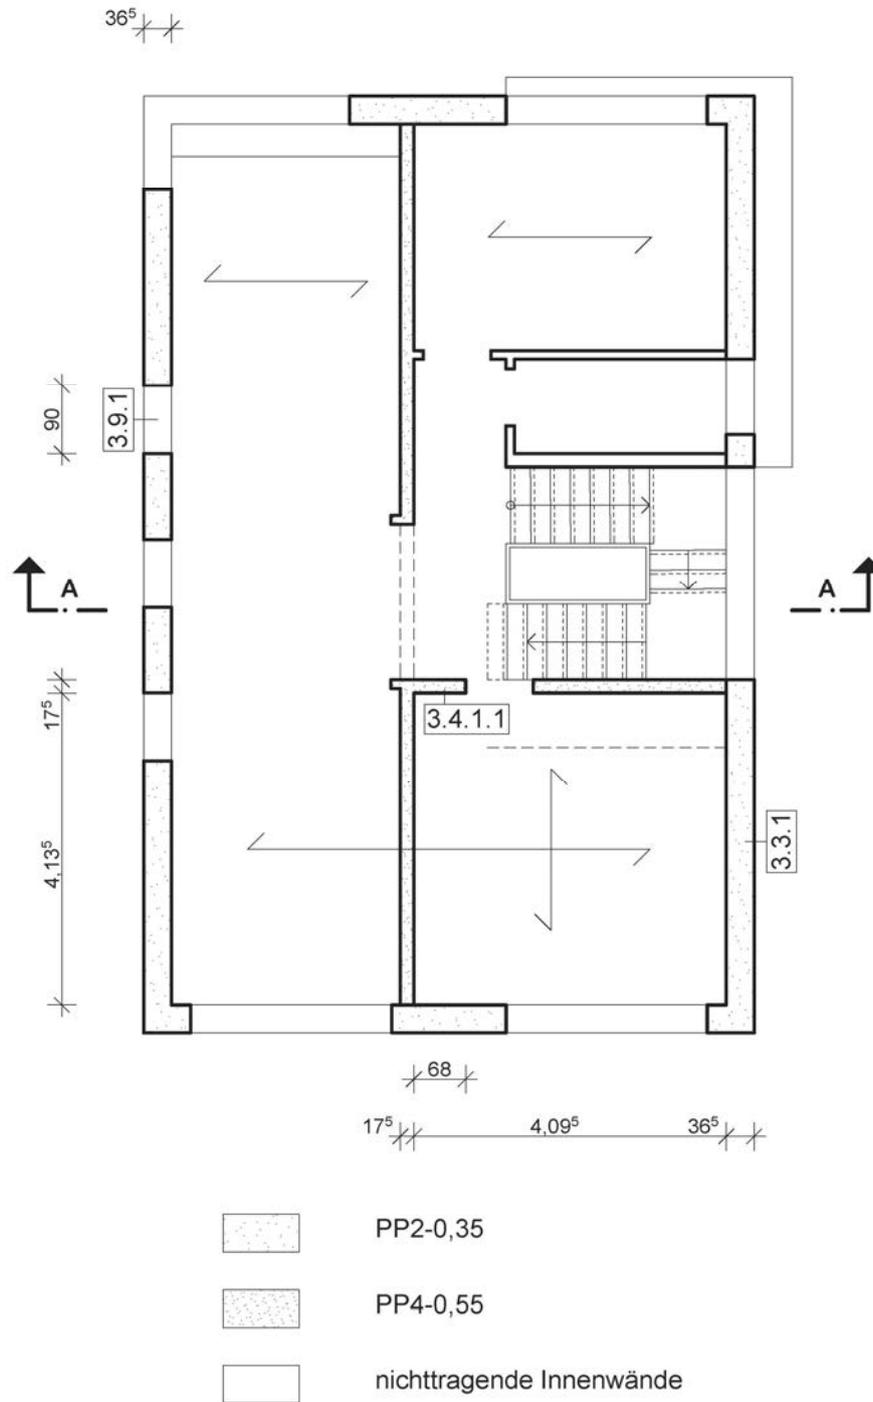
Einfamilienhaus in Berlin, Grundriss Obergeschoss
